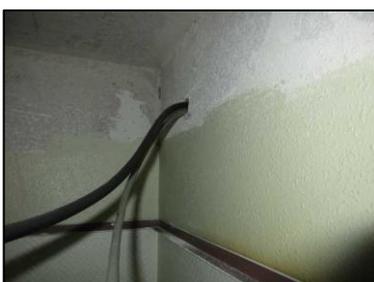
ECH-N°024 RdC mur bureau Peinture + plâtre
